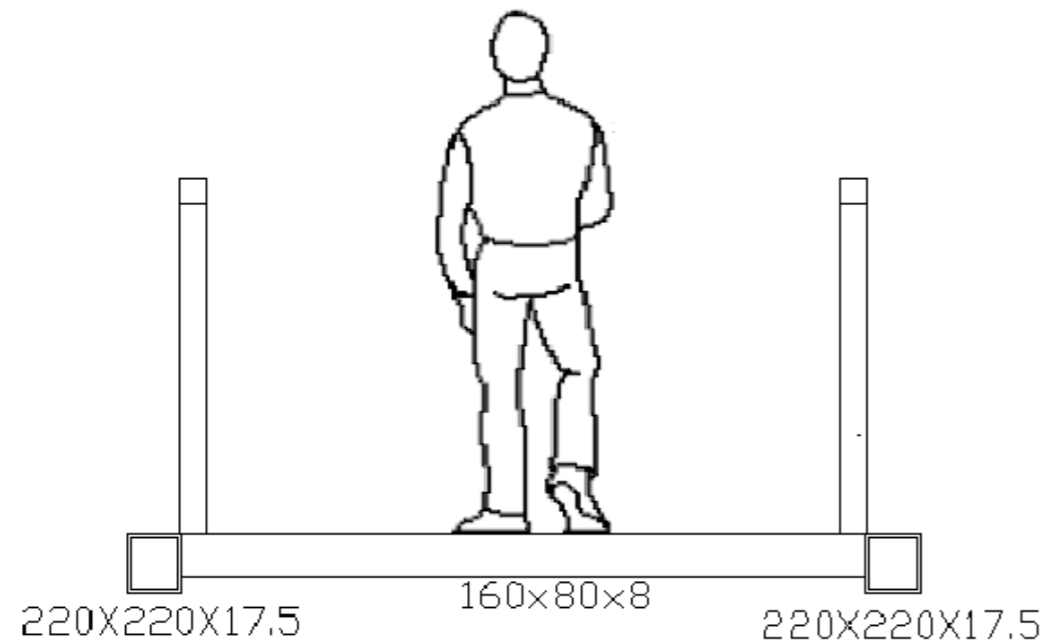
Detalle tablero pasarela peatonal Atirantada
